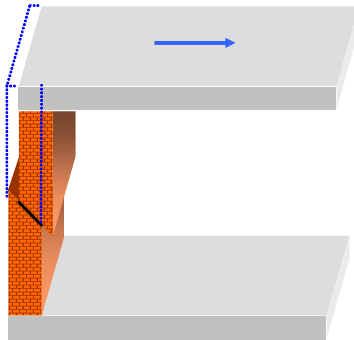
Rotura por corte numa parede por retracção da laje [61]
